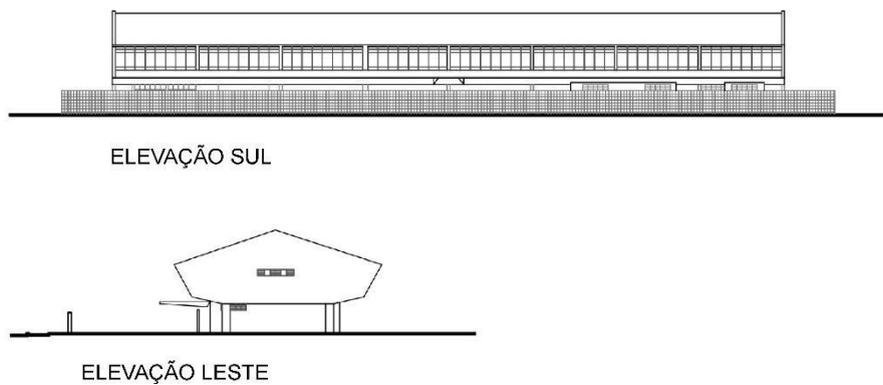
Elevações sul e leste. Fonte: Acervo ArtArqBr.
